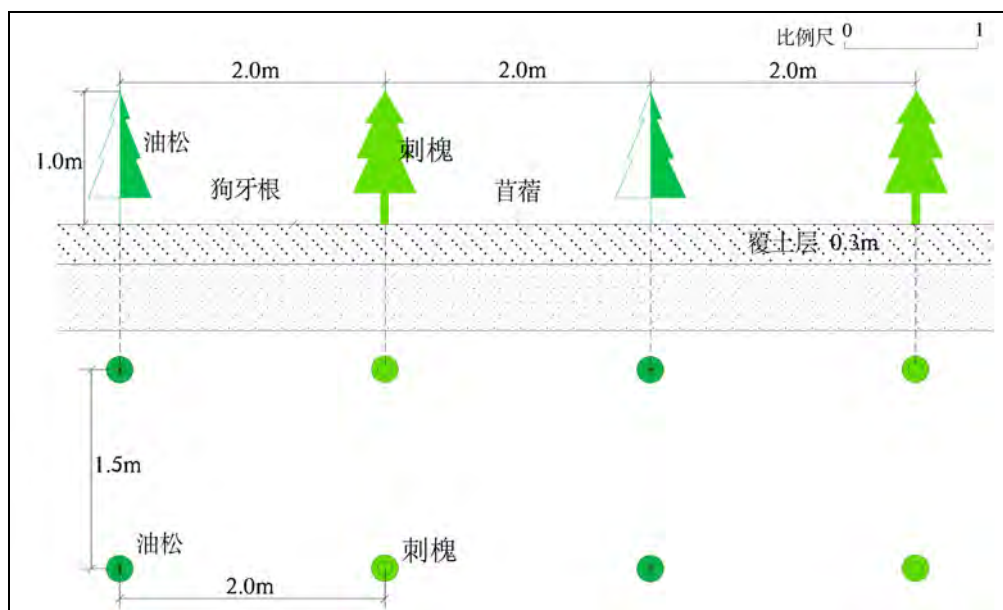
采场平台林地复垦单元工程设计立面图、平面图
